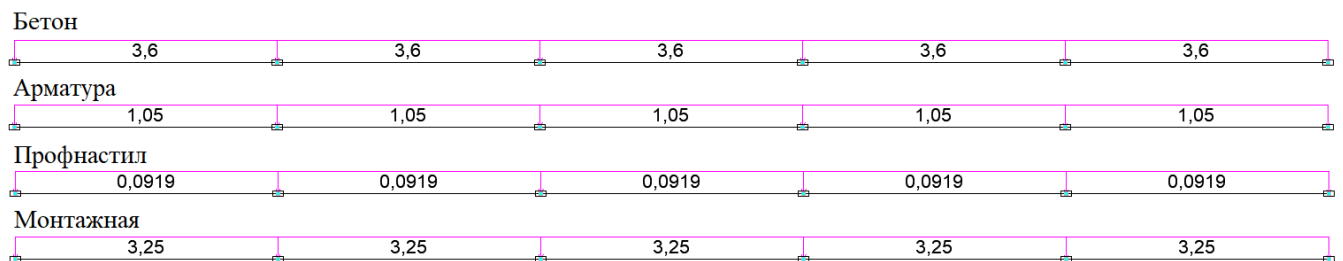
Расчетные нагрузки на профнастил на стадии бетонирования (кН/м)
